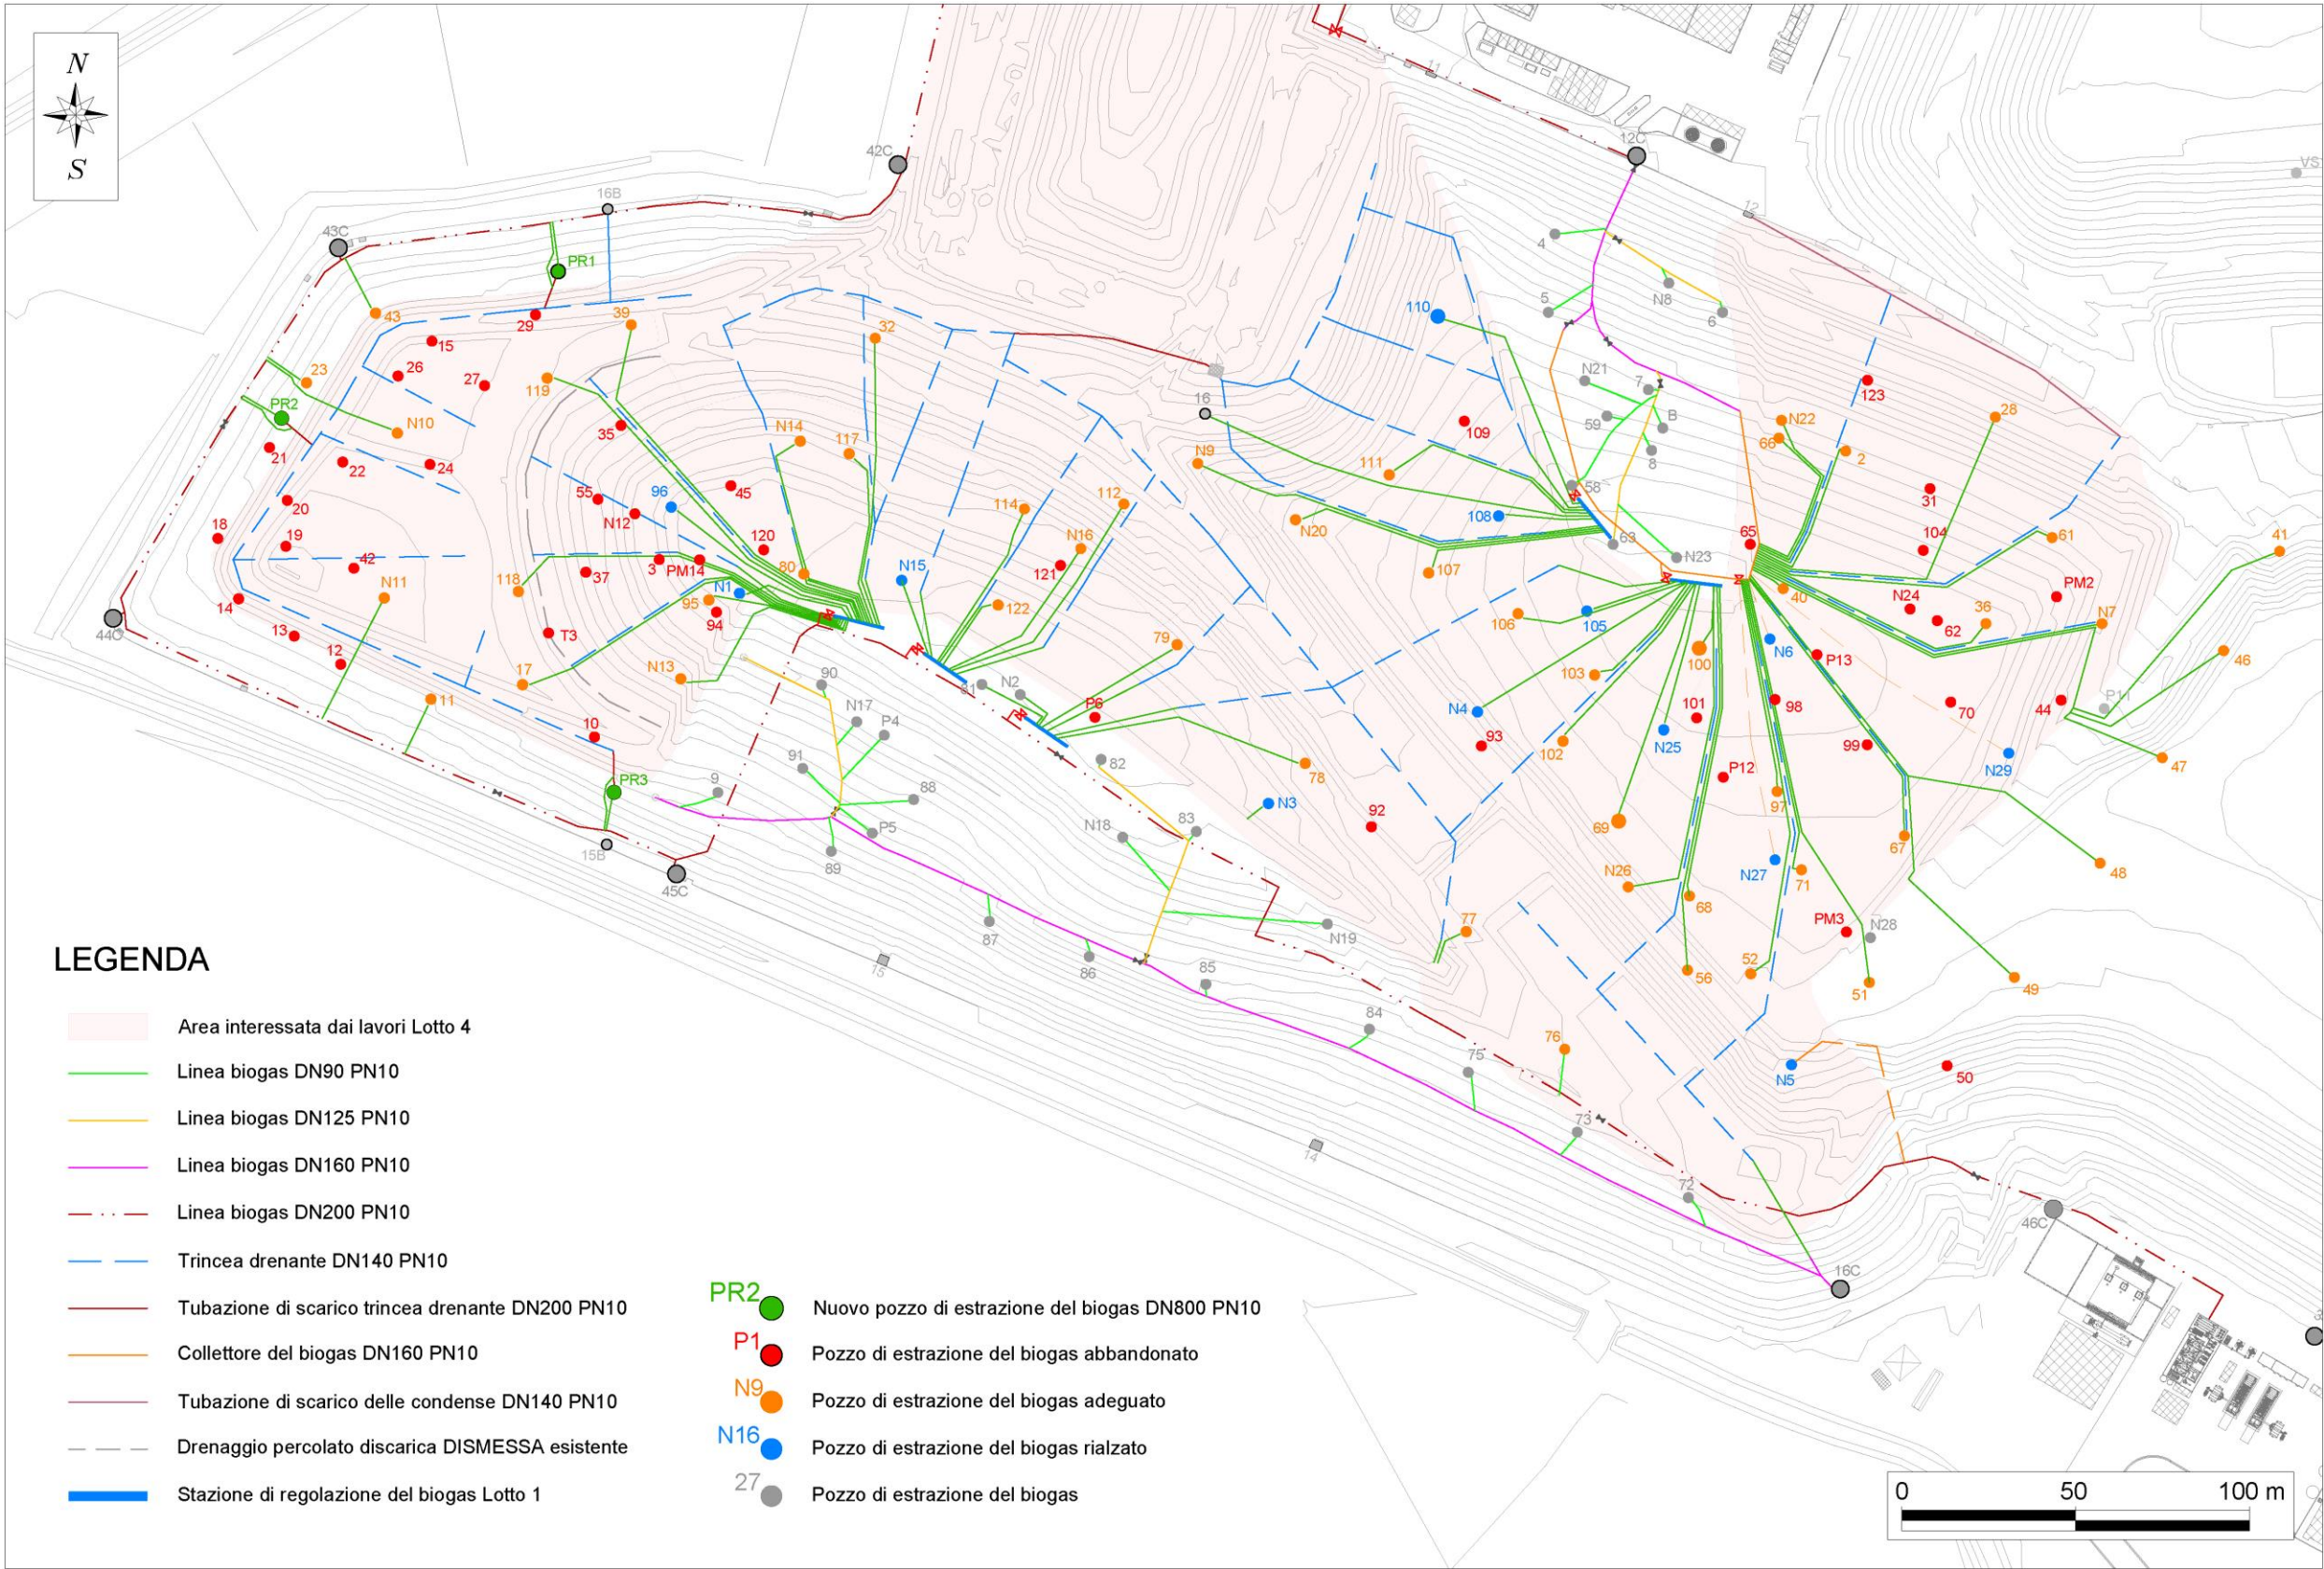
25 – Planimetria rete di captazione del biogas LOTTO 1
